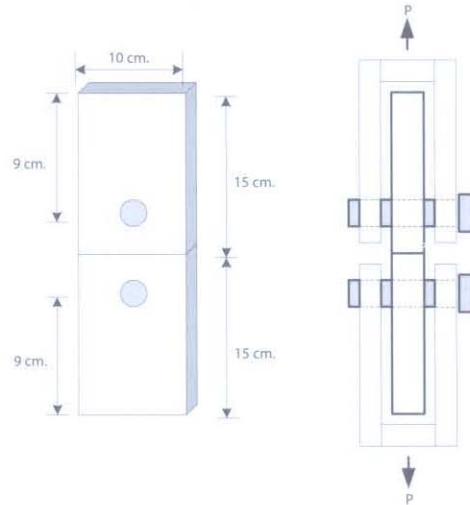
ลักษณะการทดสอบด้วยเครื่อง universal testing machine
